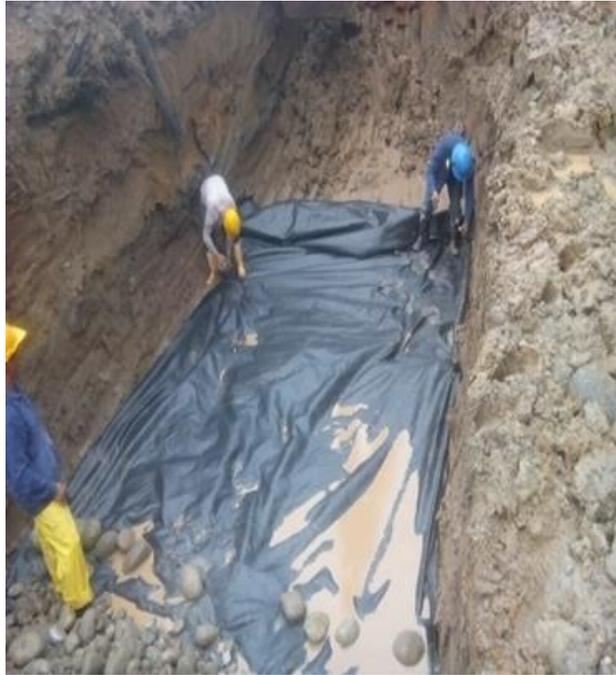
Instalación de Geotextil T 2400 (Fuente: Pasante).
